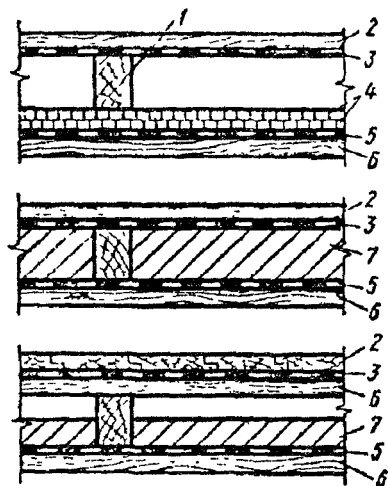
Варианты конструктивного решения каркасной стены сауны: 1 — стойка каркаса; 2 — наружная облицовка стен досками; 3 — строительная бумага; 4 — два слоя мягкого фибролита, 5 — строительная бумага на алюминиевой фольге, 6 — обшивка внутренней поверхности стены досками; 7 — минеральная вата
